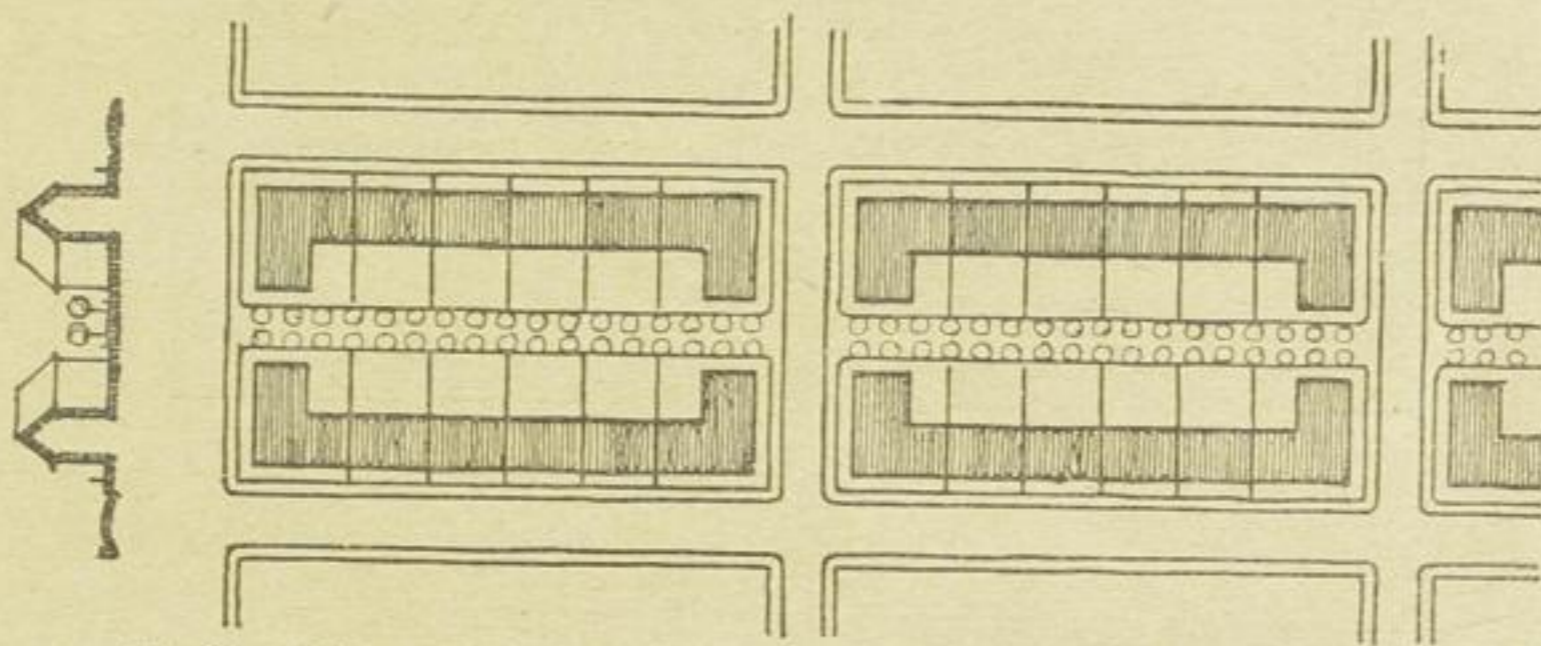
Führung einer Promenadenstraße durch das Innere von Baublöcken.
